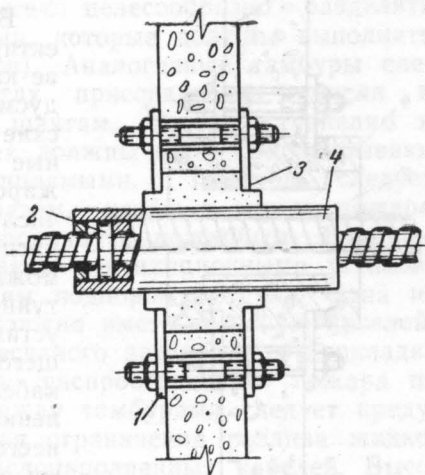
Защита отверстия в стене при пропуске электрического кабеля с помощью бетонных плит со стальными гильзами
